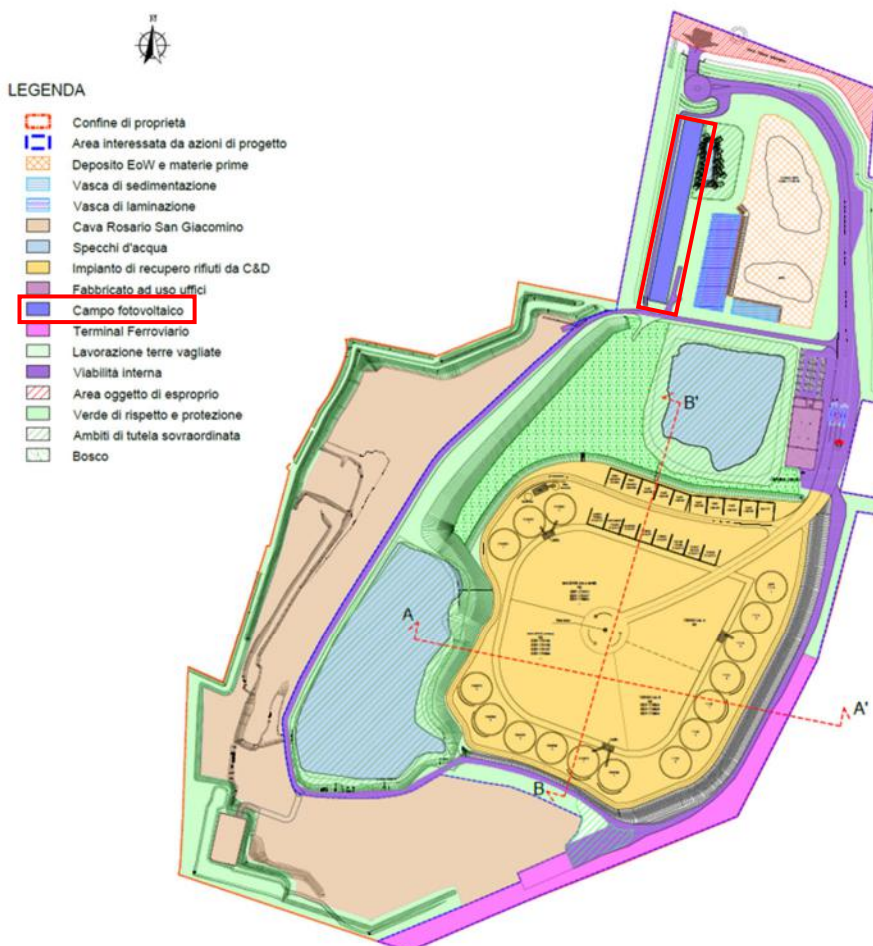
Individuazione zona impianto fotovoltaico (stralcio Tav. PF T11)
